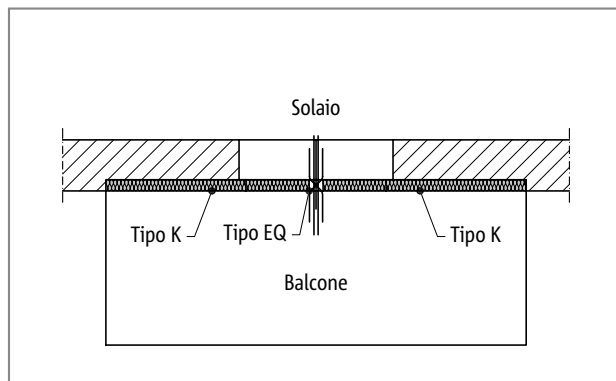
Schöck Isokorb® tipo EQ: balcone a sbalzo
